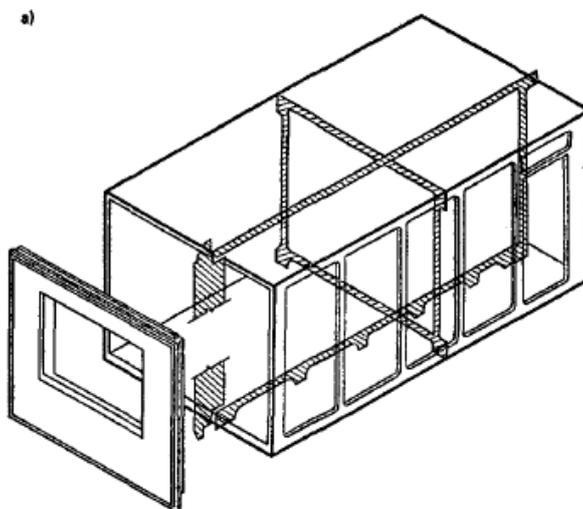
Конструктивный вид блока «лежачий стакан»
